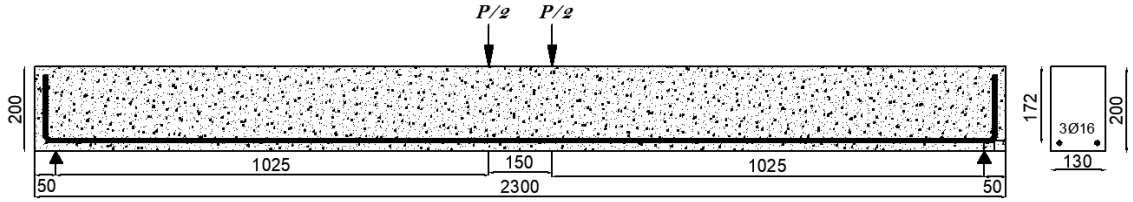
Minimum ile maksimum arası donatı oranından donatılı numunesinin geometrik özellikleri ve donatı çizimi
